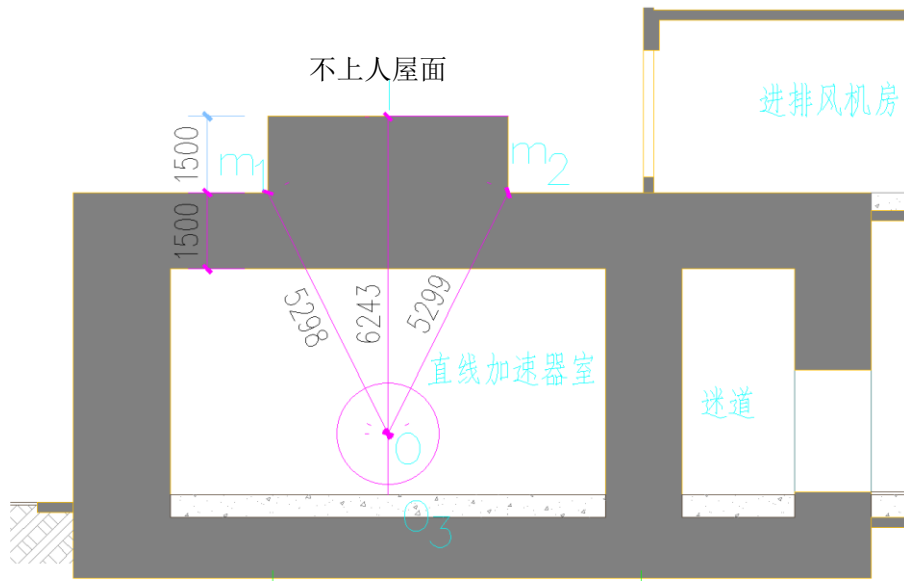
加速器机房剖面图 (单位 mm)
